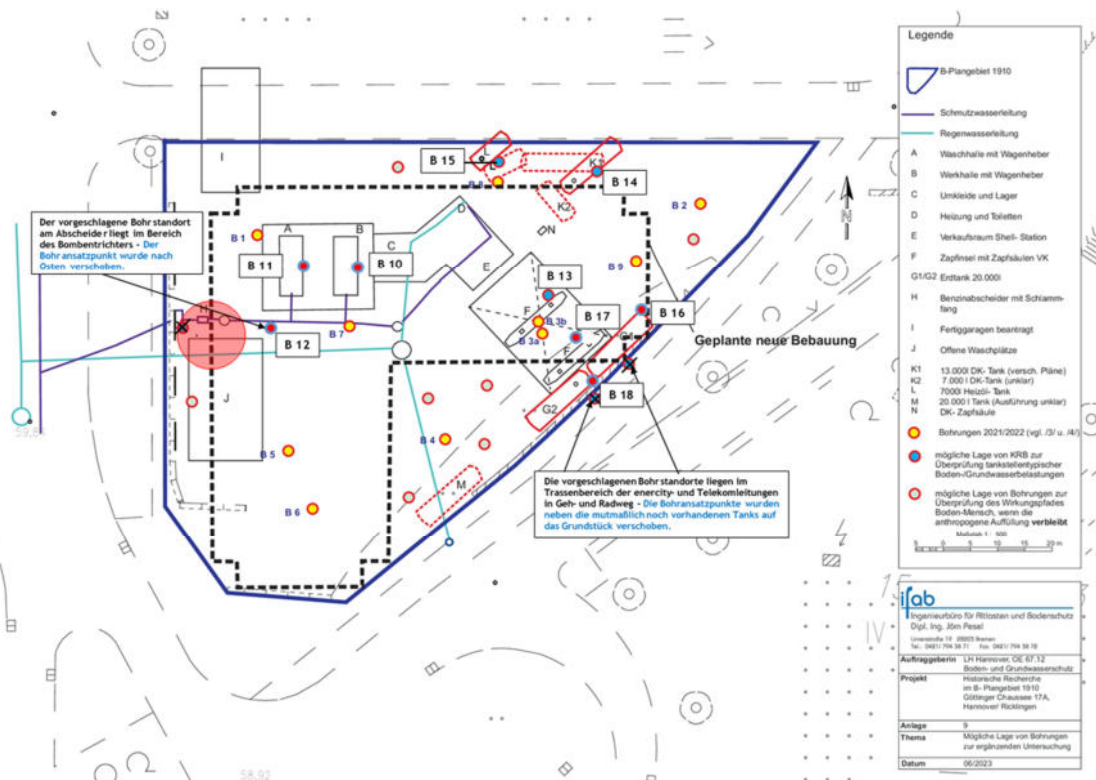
Bohrprofile und Lageplan der Bohransatzpunkte der ergänzenden Erkundungen vom August 2023
